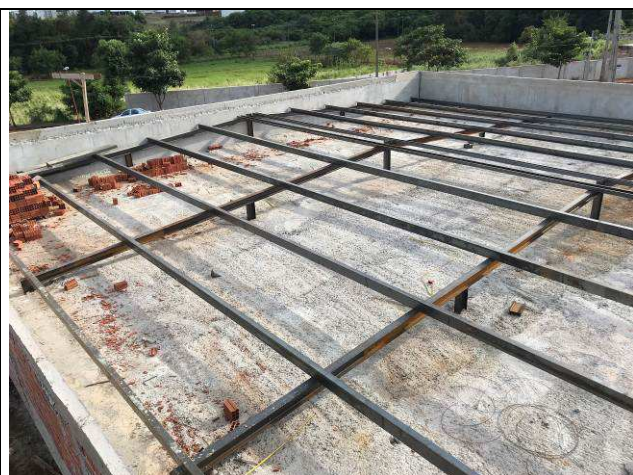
C: Estrutura metálica de cobertura - pórticos e terças - ligações.
